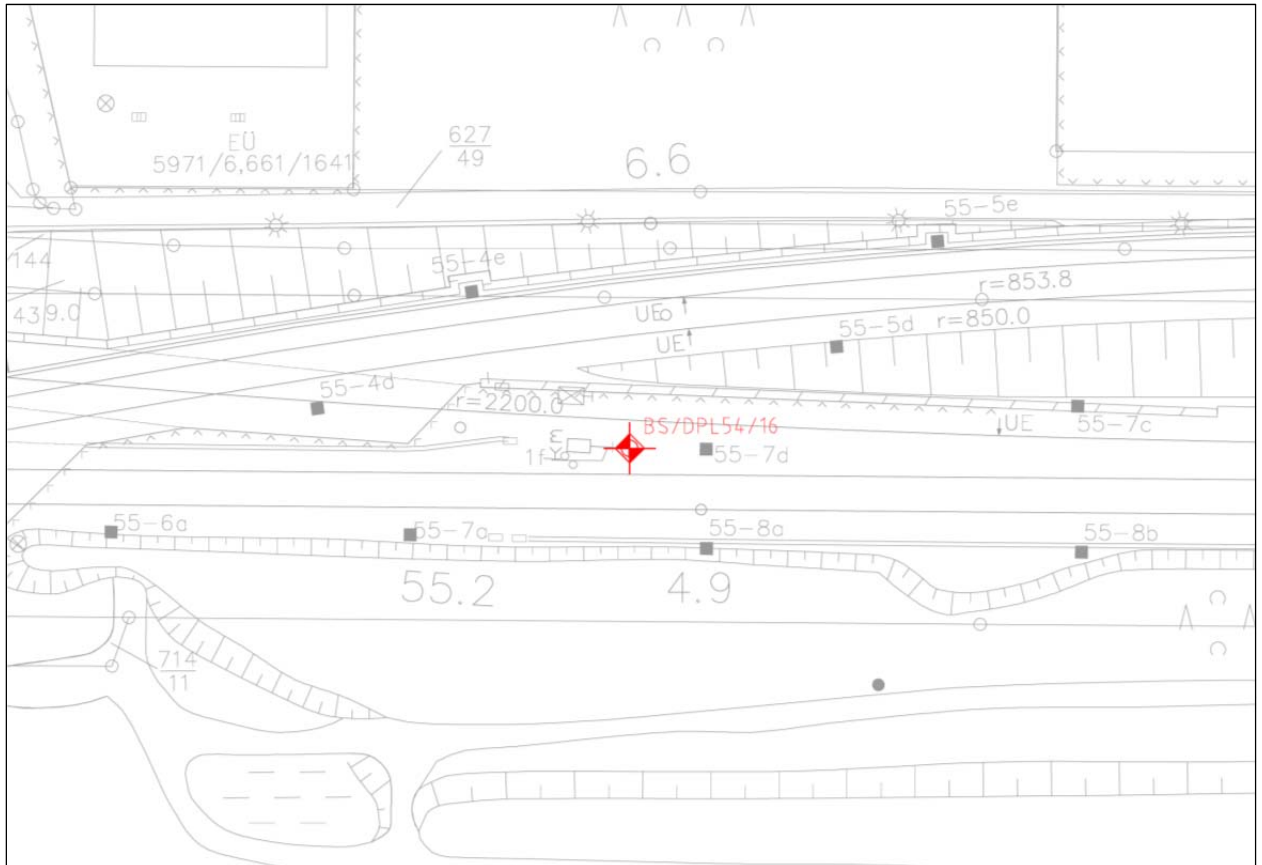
Ausschnitt aus dem IVL Plan mit Lage der BS + DPH54/16
